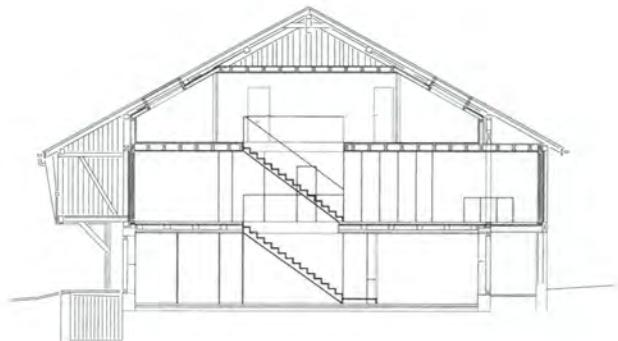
Coupe transversale sur la travée des étables après transformation.
